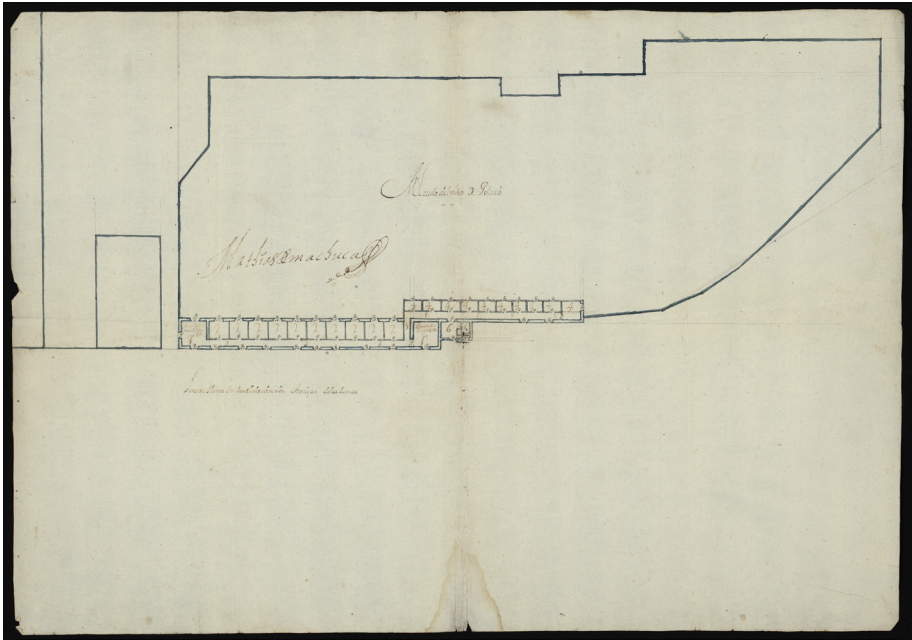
"Terzera planta donde se alla la avitazi3n antigua de las damas". Matías Machuca, ca. 1730. Fuente: Archivo de la Fundaci3n Casa Ducal de Medinaceli, n3 563 y 564.
